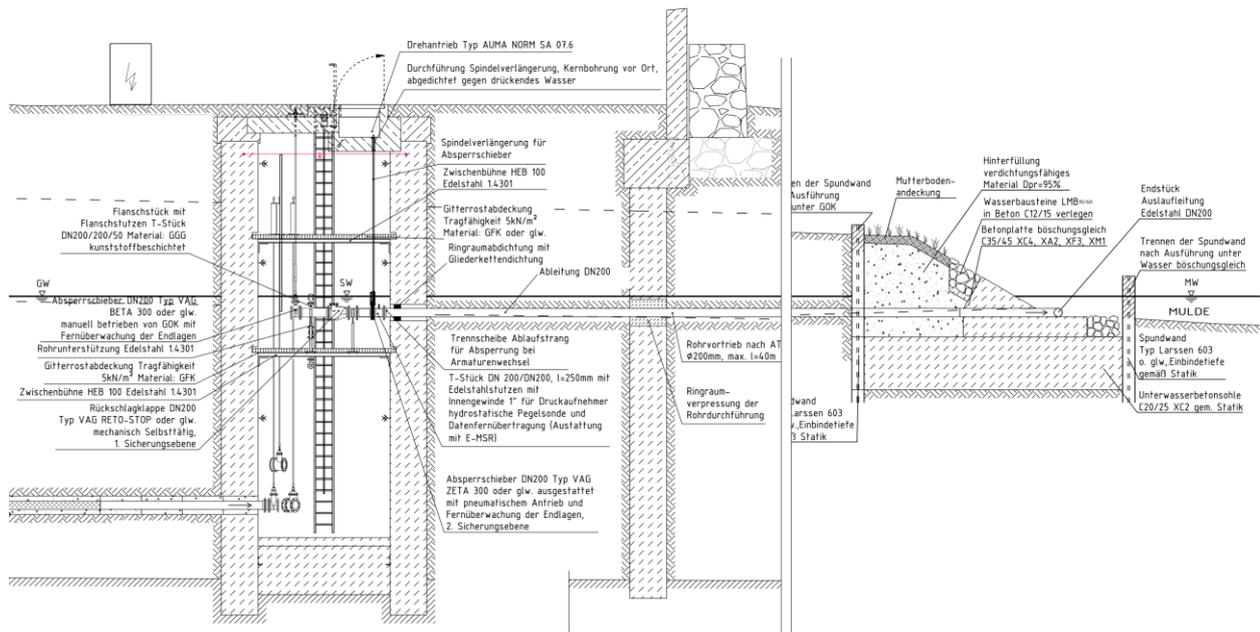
Schnittdarstellung Ableitung und Auslaufbauwerk
